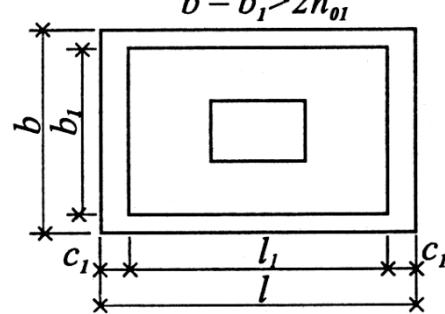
Схема к расчету фундамента на продавливание дна стакана колонной
